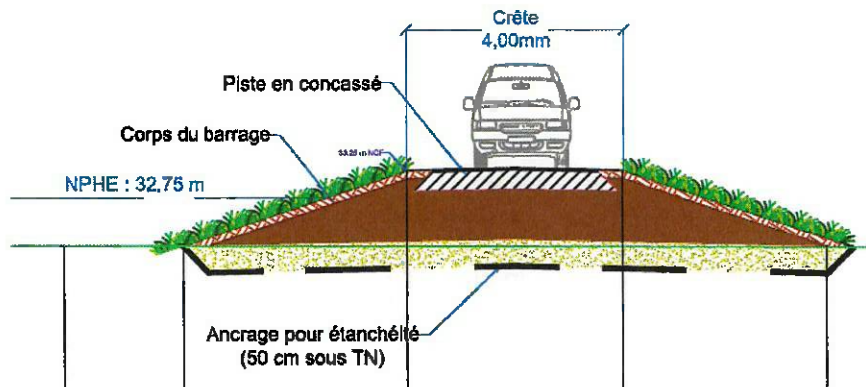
Extrait du plan de masse- coupe en travers du corps d'ouvrage - Steenbecque
